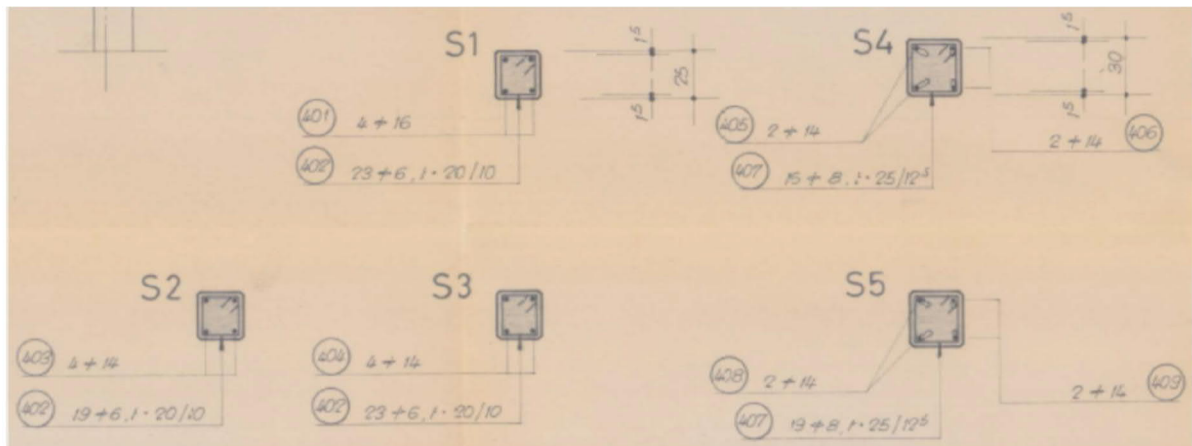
Armature des piliers S1 à S5 dans la partie 2 du bâtiment, bâtiment scolaire.
